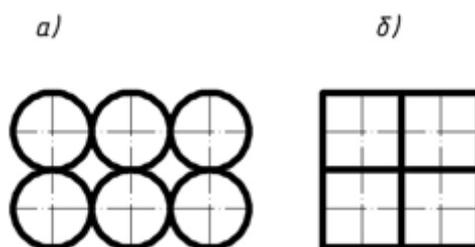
Виды сечений силосов на плане. а) Силосы с круглым сечением; б) силосы с квадратным сечением
